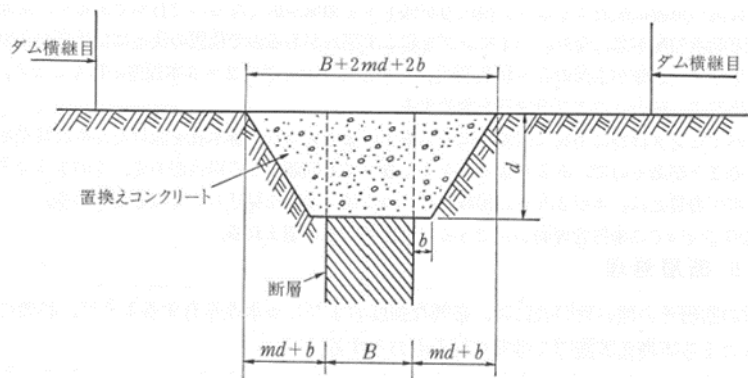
ダム軸と直角に近い角度で交わる断層のコンクリートによる置換え処理
